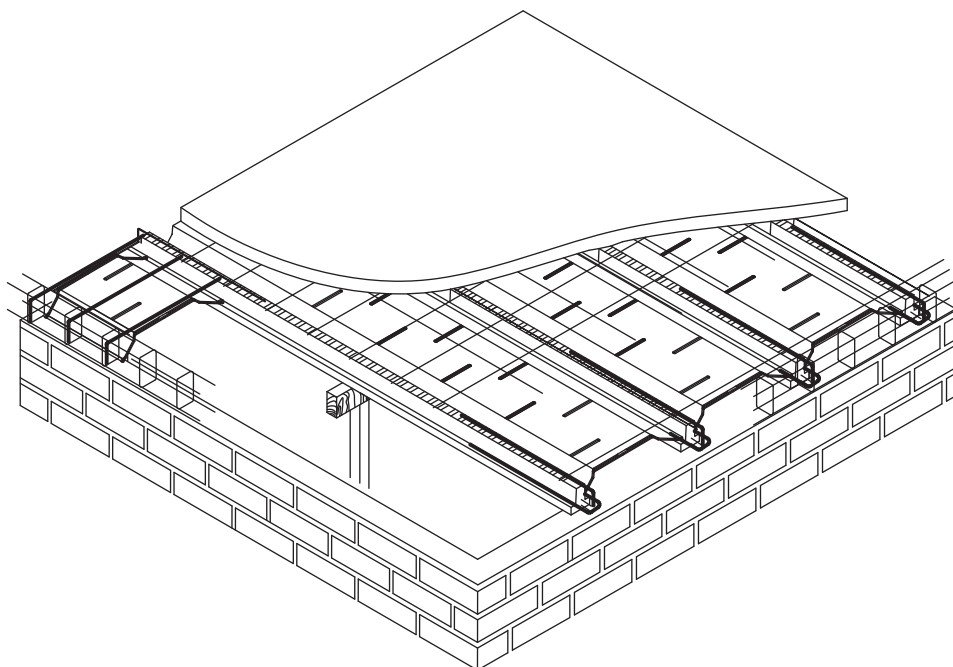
Схема армирования перекрытия для здания, в сейсмоопасных районах
